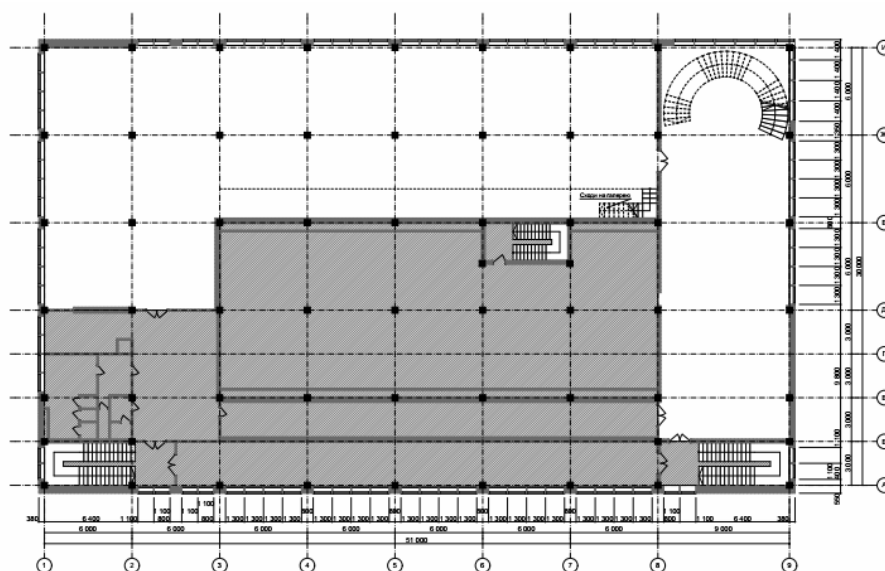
План до перепланування 2-го поверху науково-дослідницької бібліотеки
